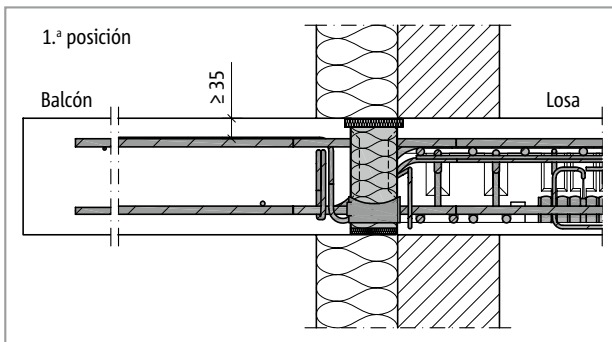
Schöck Isokorb® T tipo C: Sección 1.ª posición; conexión para sistema de aislamiento térmico exterior (SATE)
